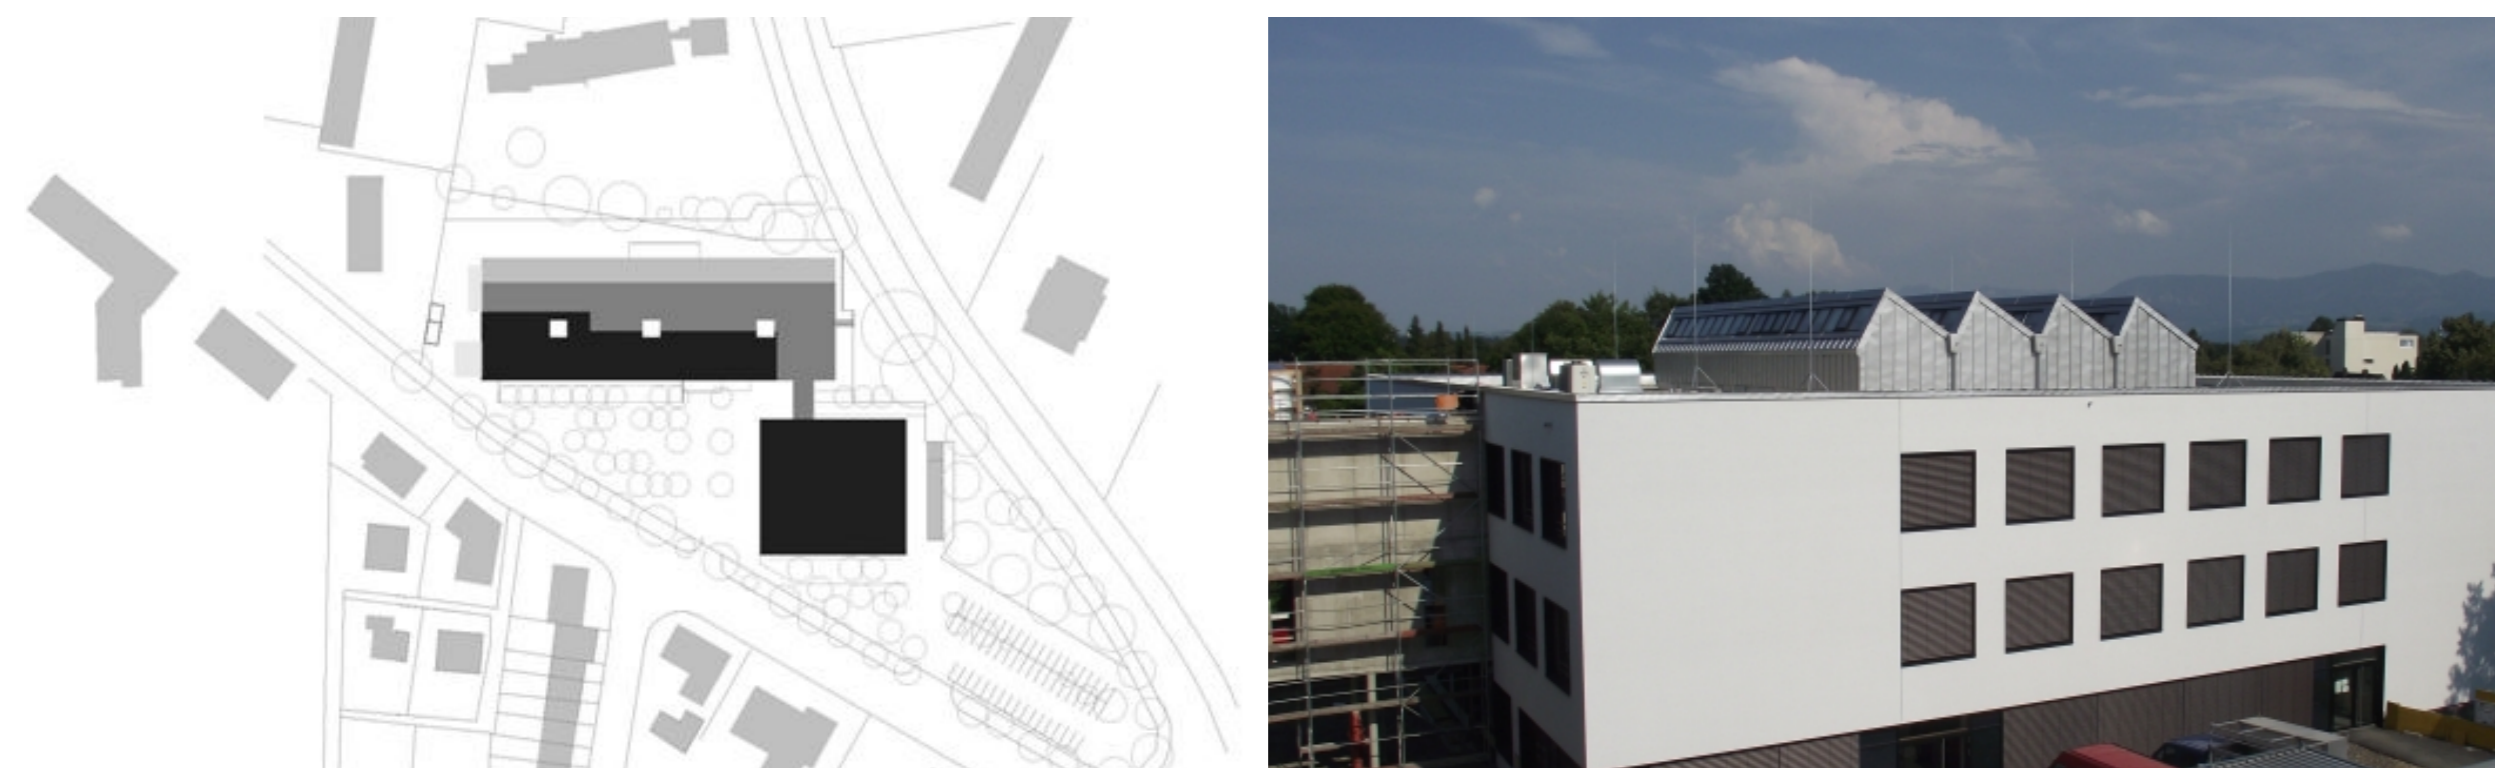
, 2 und 3: Lageplan und Aussenansichten der beiden Gebäudeteile
